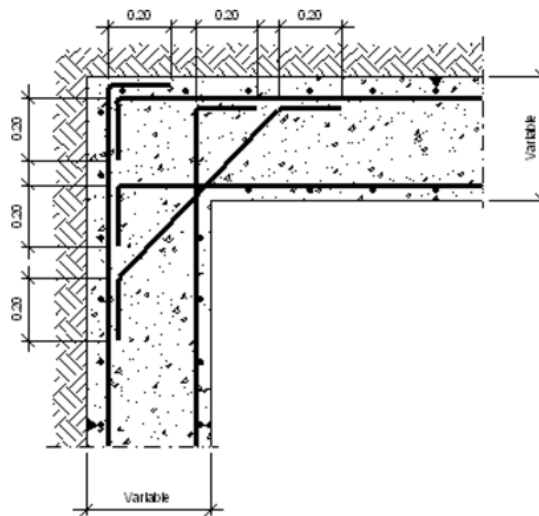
Detalle de muros pantalla encuentro en esquina
